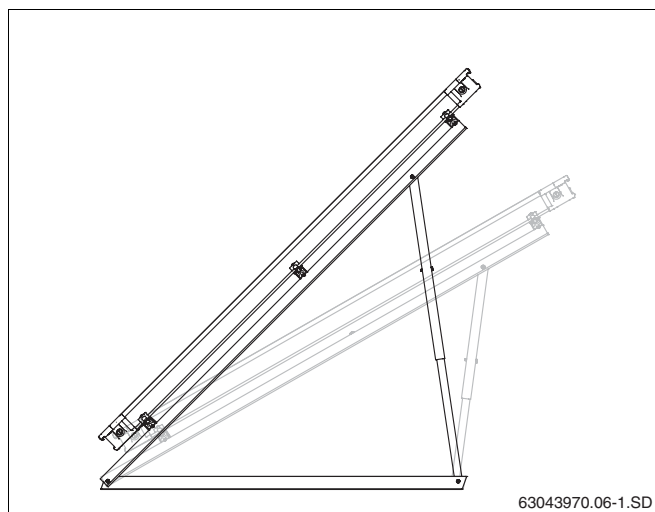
Solpanelens inställningsvinkel på ett plant tak
